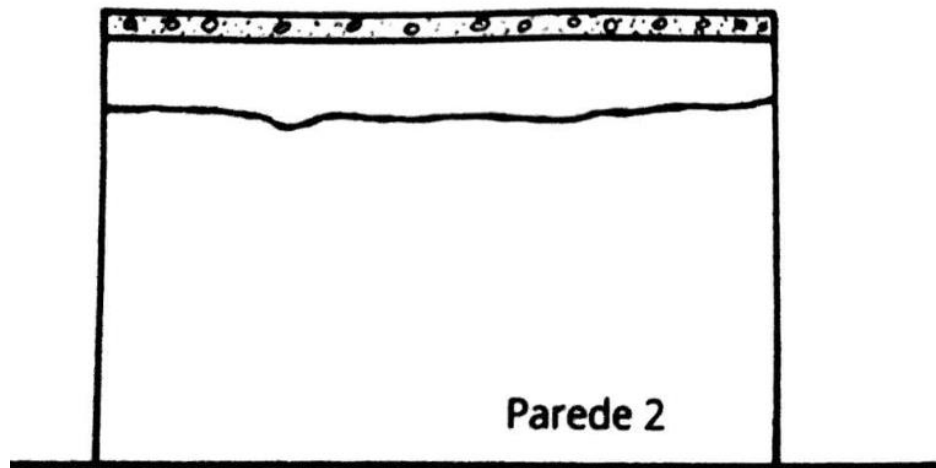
Trinca típica presente no topo da parede paralela ao comprimento da laje
